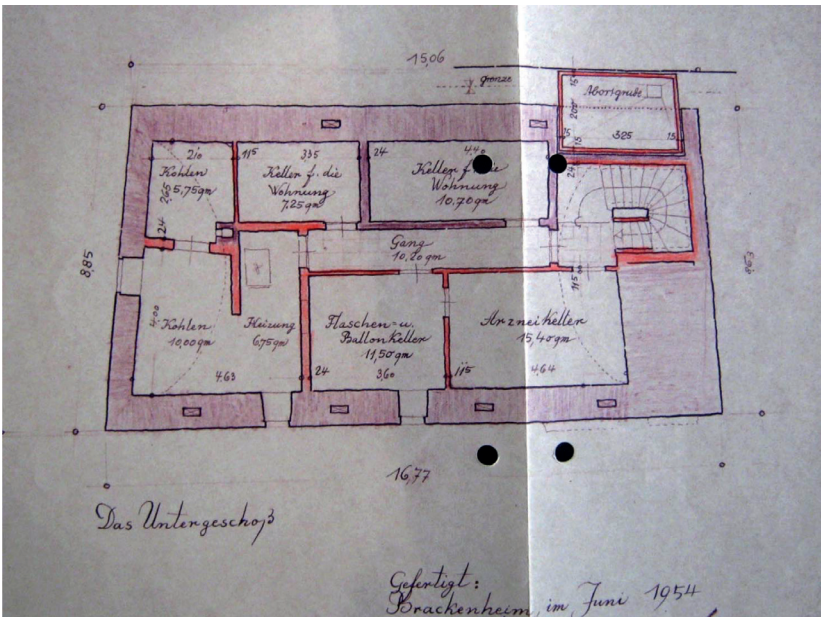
Handgezeichneter Grundriss des Arzneikellers der Brackheimer Apotheke aus dem Jahre 1954. Rot eingefärbt sind die im Rahmen des Umbaus neu eingezogenen Wände zu erkennen.
